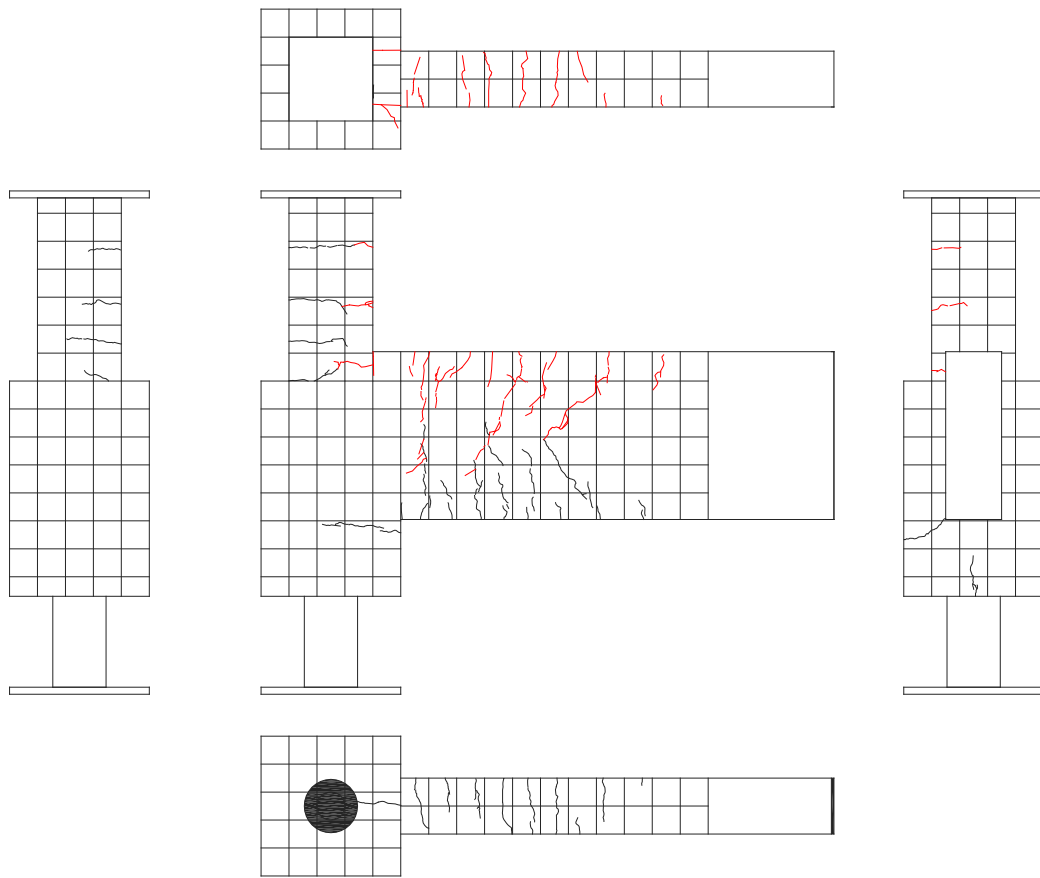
試験体 A-5 ひび割れ状況 (2Cycle)
